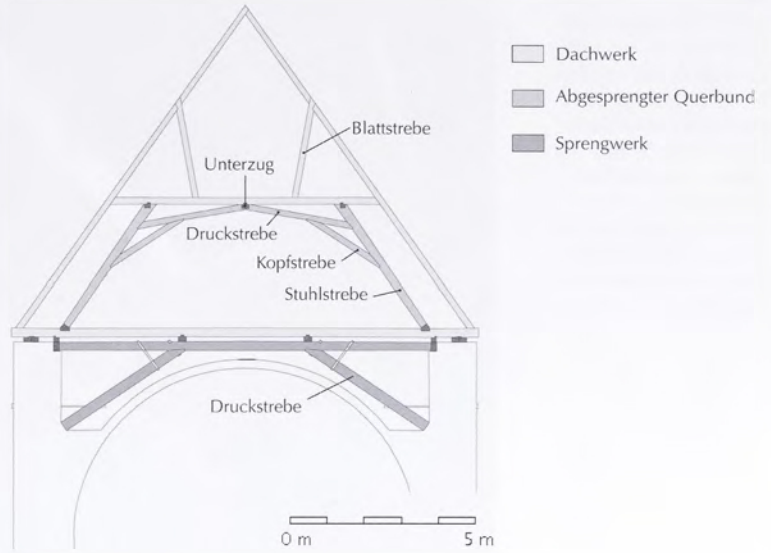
(rechts): Dachwerk mit eingestellten abgesprengten Querbünden sowie Sprengbünden unterhalb der Dachbalkenlage, Umzeichnung nach einem anonymen Entwurf aus dem frühen 17. Jh.
